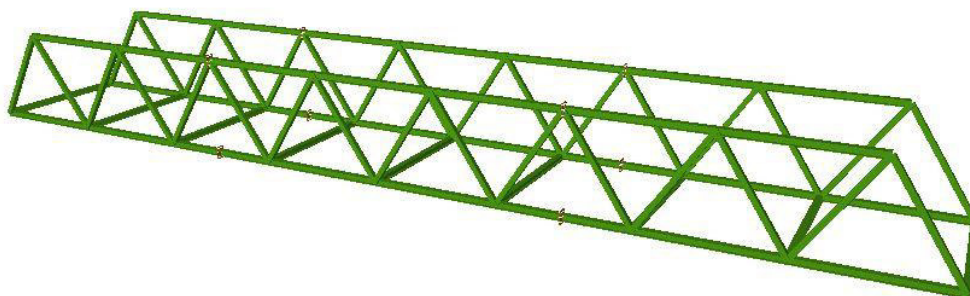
Imagen 3D del puente de 16,00 m de longitud
